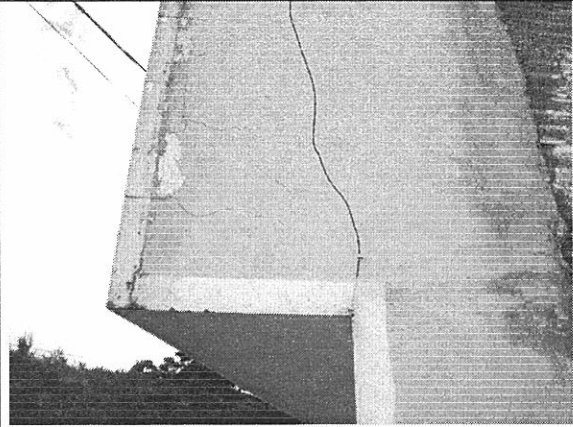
Fisuras en el acabado de los muros laterales
